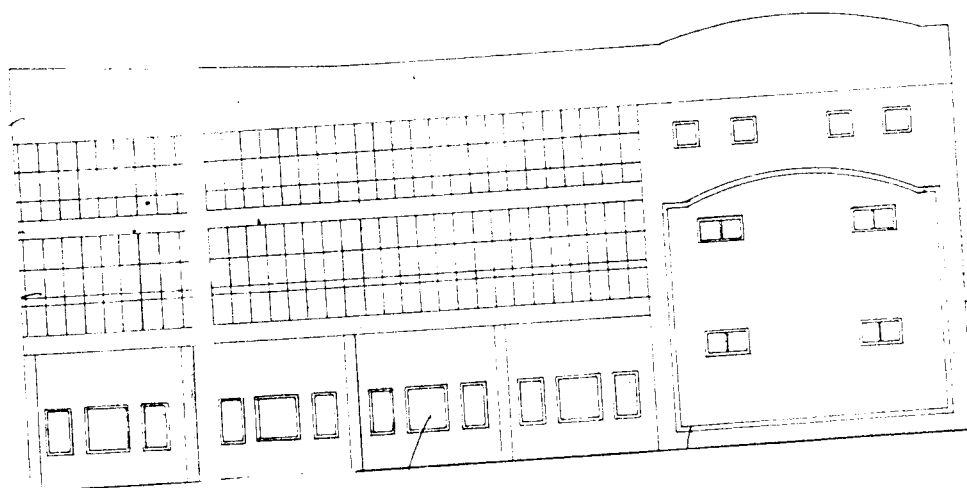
Penampilan Bangunan dari arah jalan Nusa Indah
